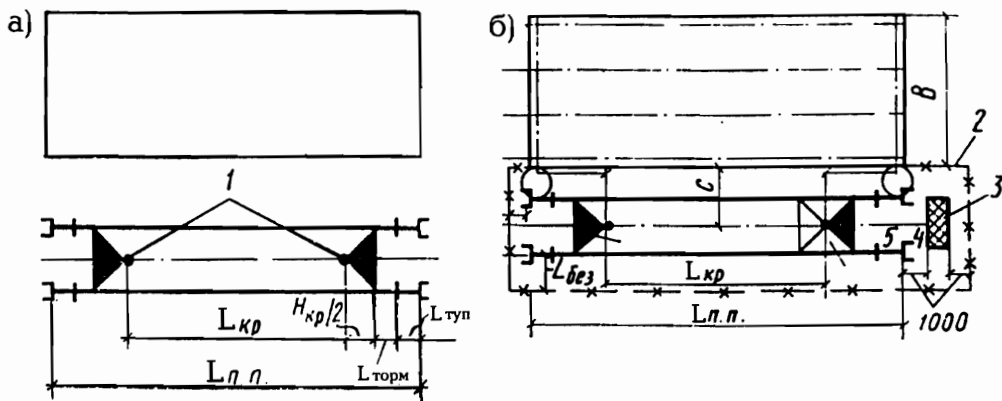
Расчет и обозначение подкрановых путей на стройгенплане: а – определение минимальной длины подкрановых путей; б – привязка путей. 1 – крайние стоянки крана; 2 – привязка крайней стоянки к оси здания; 3 – контрольный груз; 4 – конец рельса; 5 – место установки тупика
